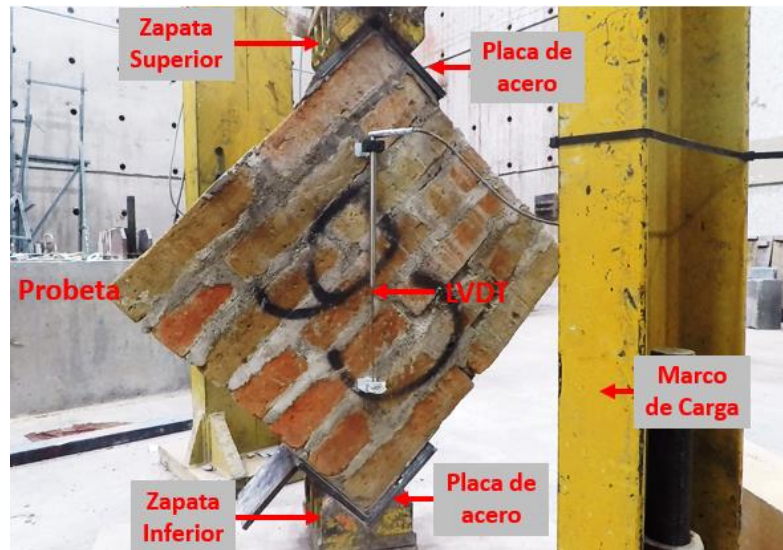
Esquema de ensayo a tensión de muretes de mampostería
